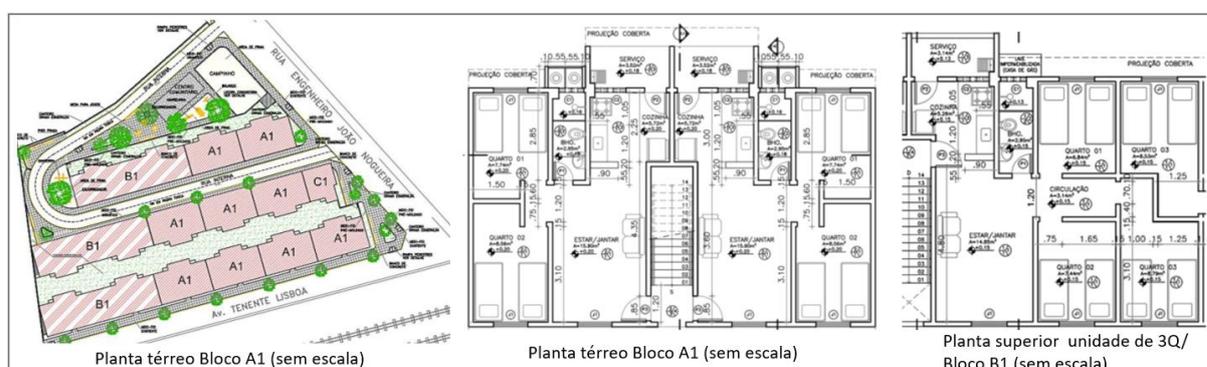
Plantas de implantação e plantas baixas do Conjunto socorro Abreu.
